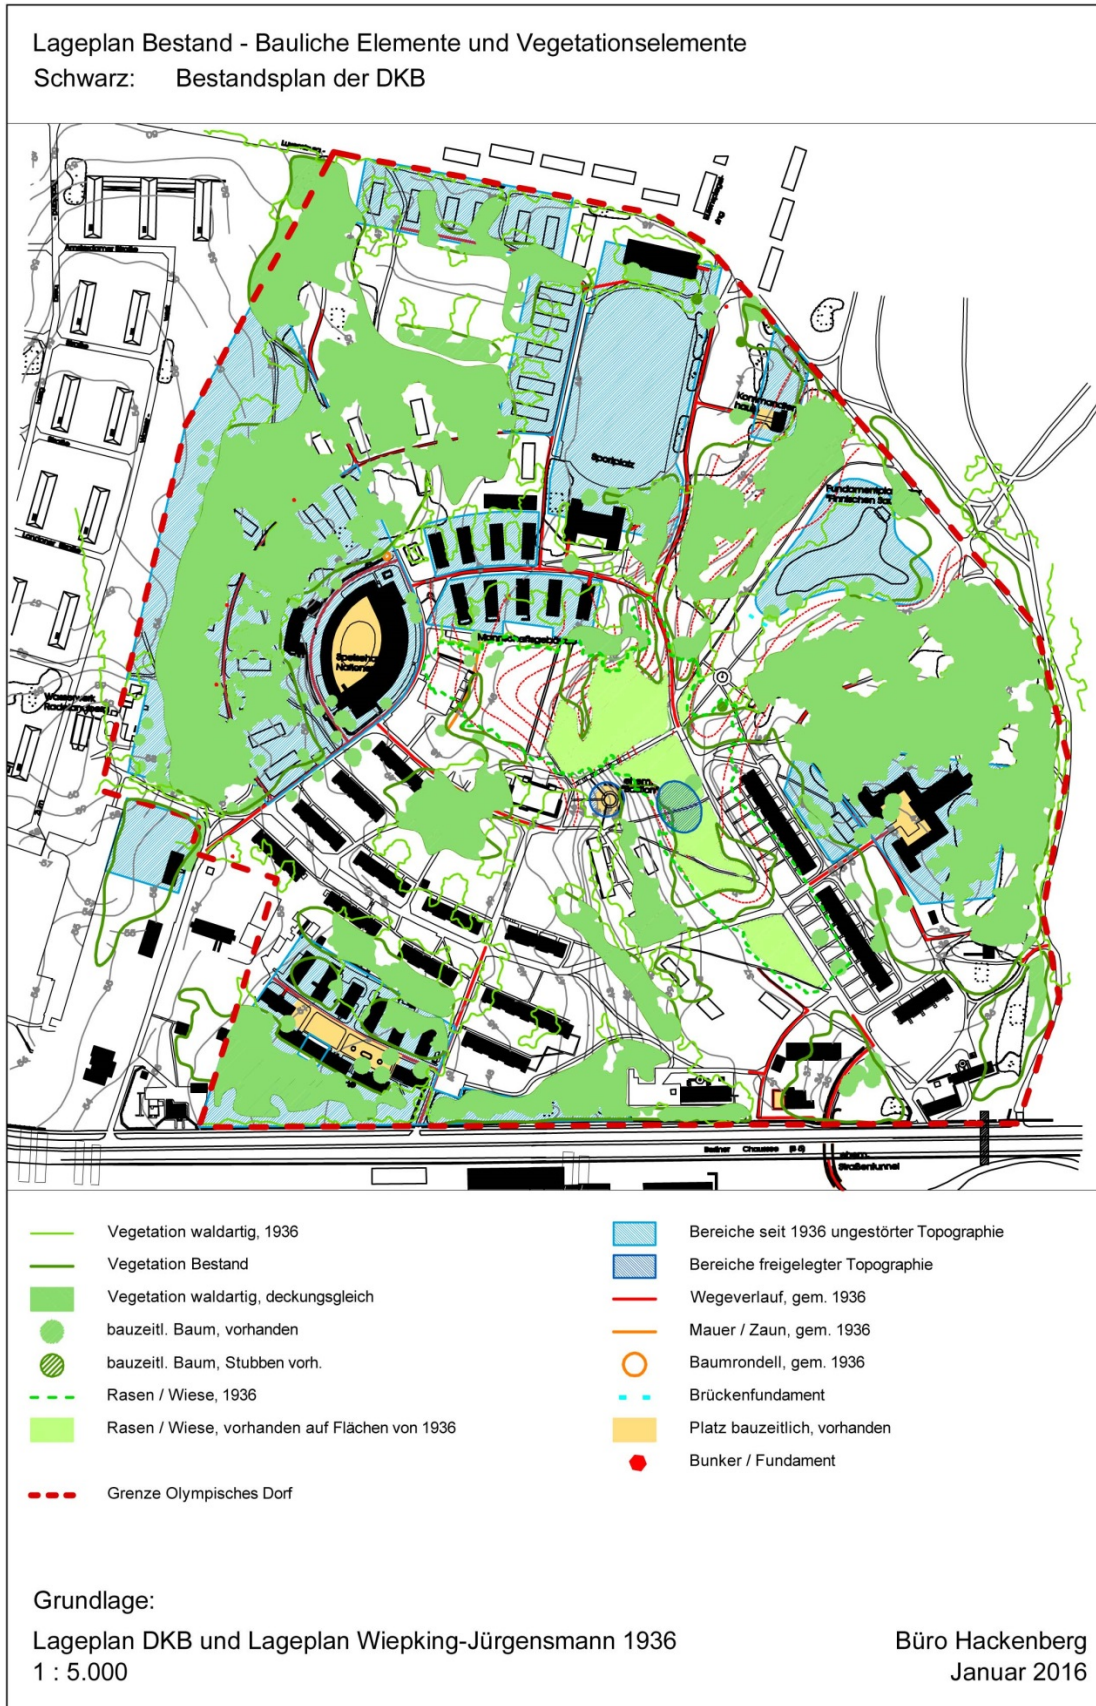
Lageplan Bestand – Bauliche Elemente und Vegetationselemente
